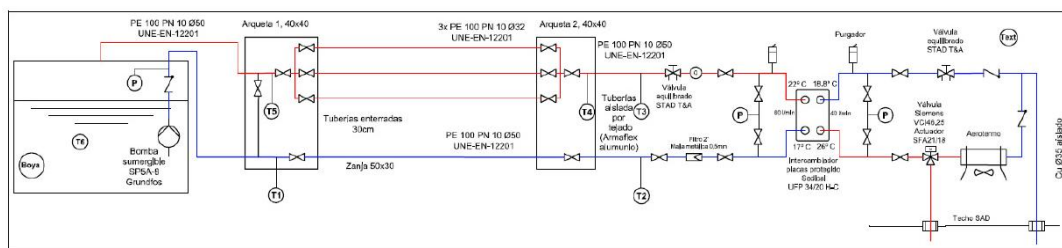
Plano detallado del sistema de disipación geotérmico
